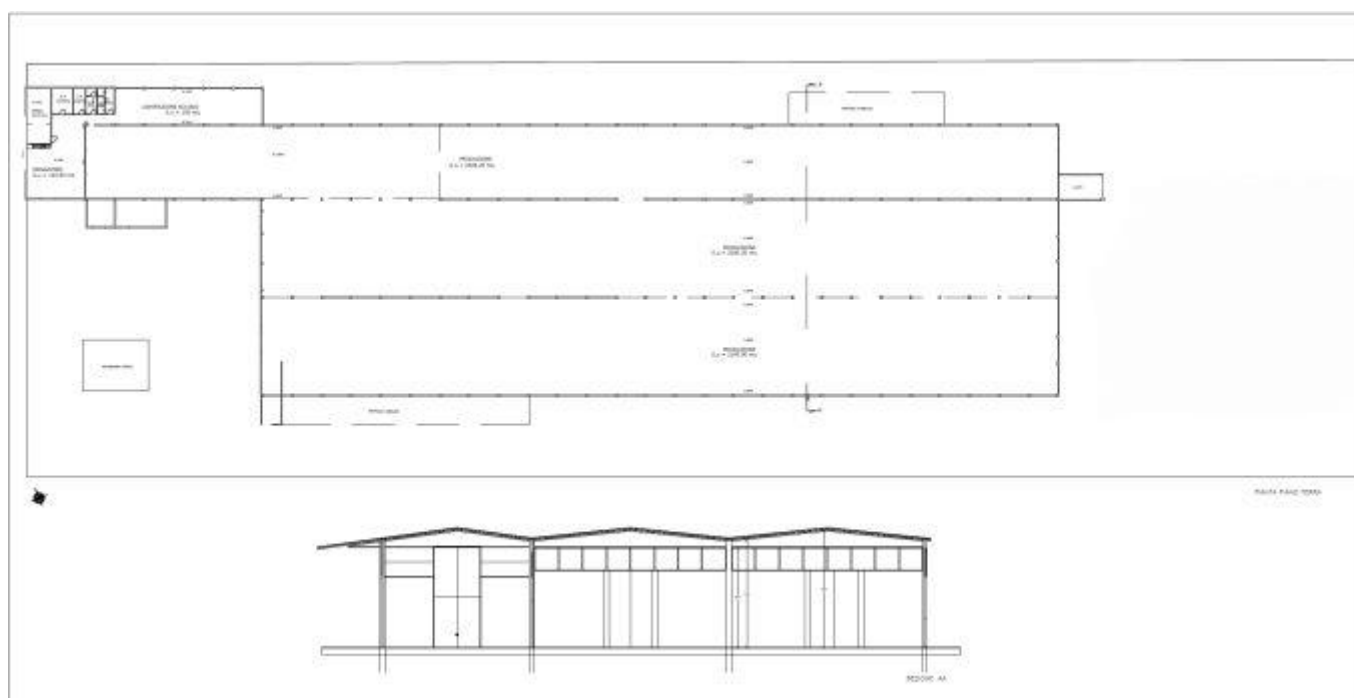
Planimetria e sezione del fabbricato artigianale (fuori scala).
